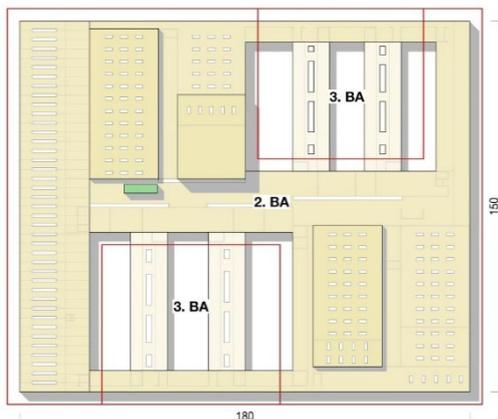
Grundriss mit Bauabschnitten
